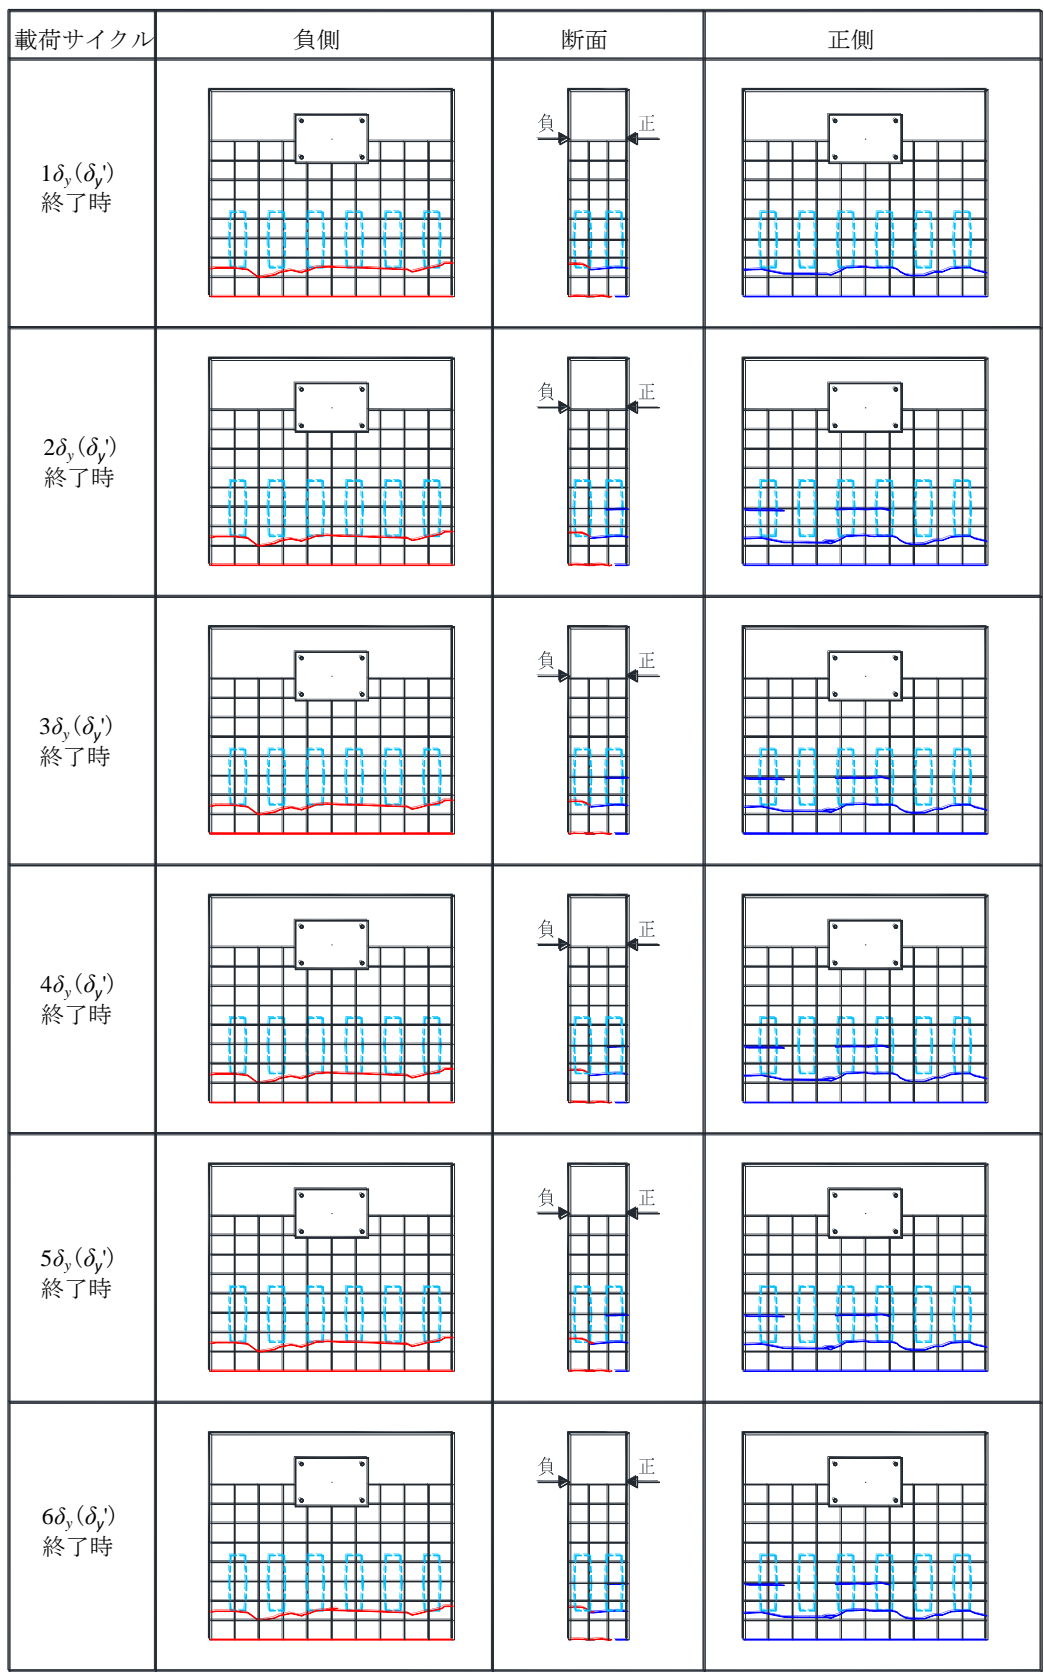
JD13B 試験体ひび割れ図 ($1\delta_y \sim 6\delta_y$)
